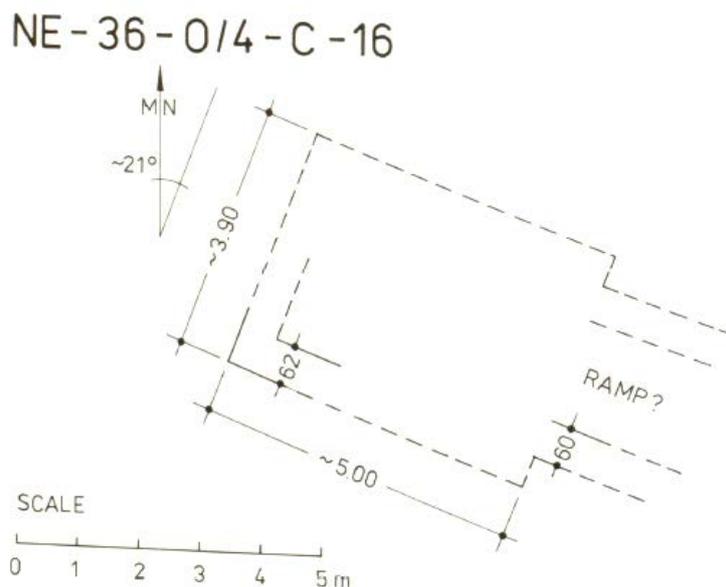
Planta del edificio hallado en el-Hosh (HINKEL 1985: Fig.5).
